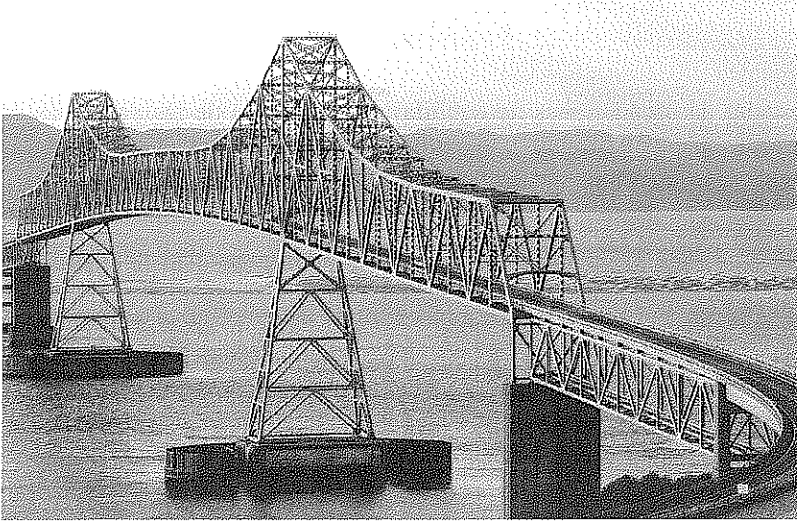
Esta armadura de puente se compone de elementos de dos fuerzas que pueden estar en tensión o en compresión.
